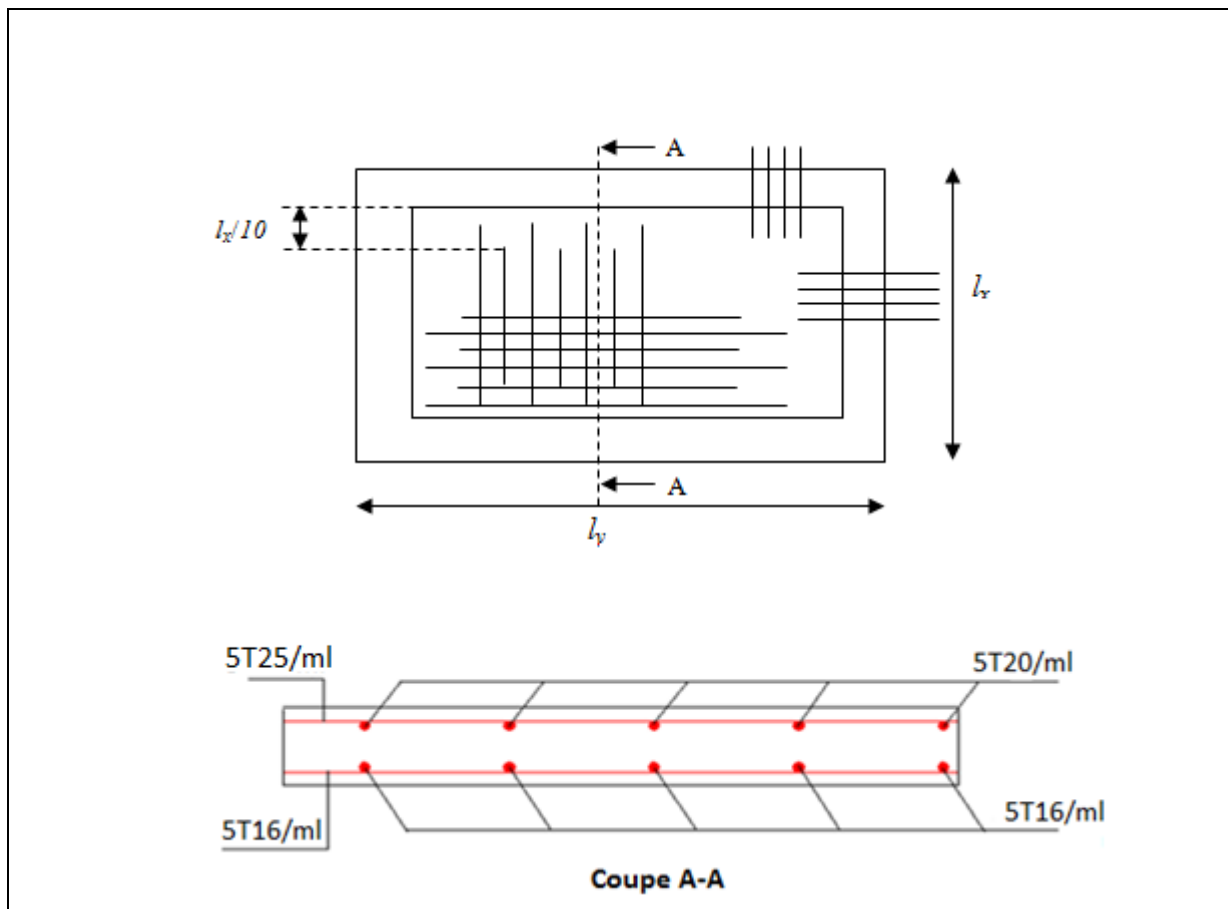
Schéma de ferrailage de la dalle de radier.
